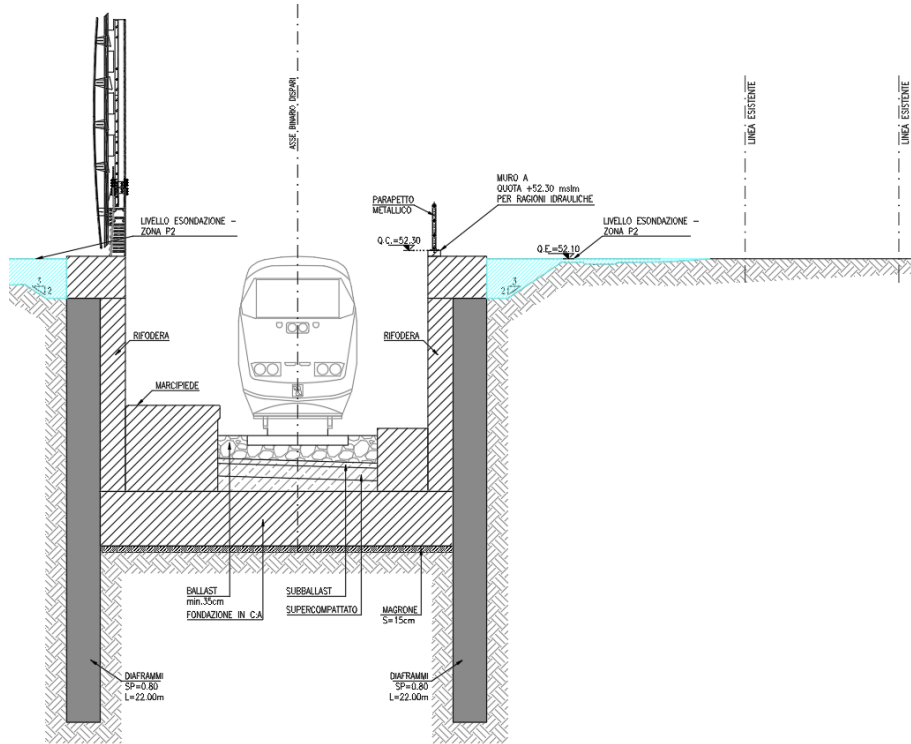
Sezione trasversale TR02 BD con indicazione quota di esondazione
